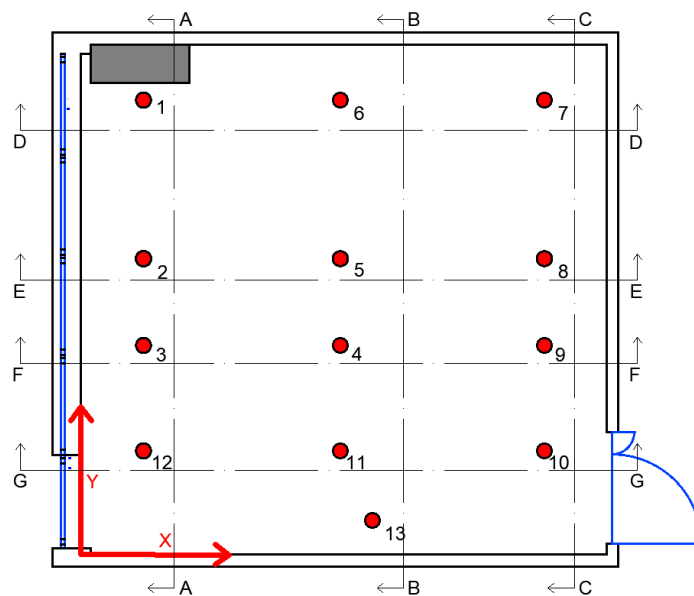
Planimetria aula Falconara con individuazione di tutti i punti di presa e sezioni
